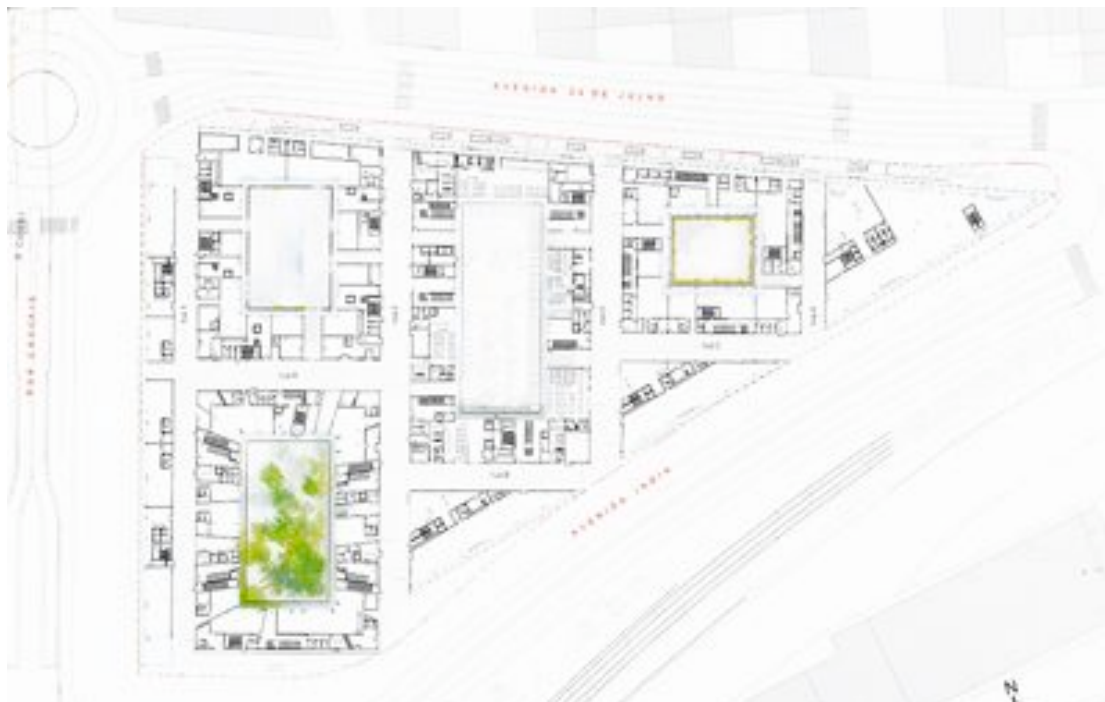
, Planta de enquadramento do plano de Jean Nouvel¹¹²
